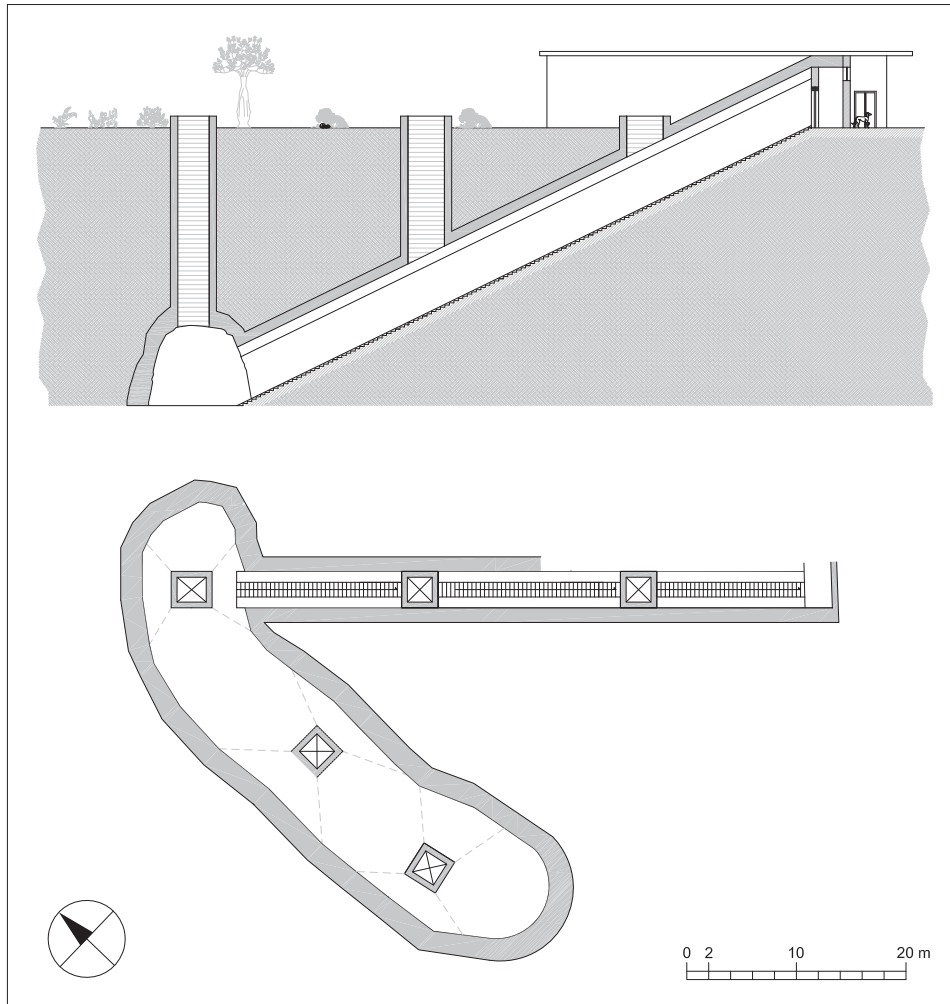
Gallo, cantina C9. Pianta e sezione trasversale
